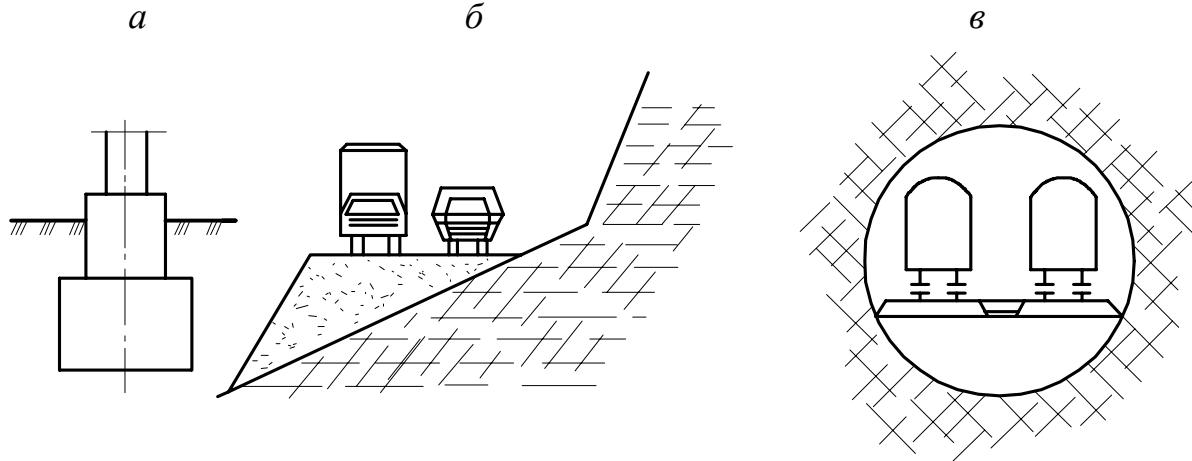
Использование грунта в строительных целях: а – фундамент здания; б – насыпь; в – подземное сооружение
